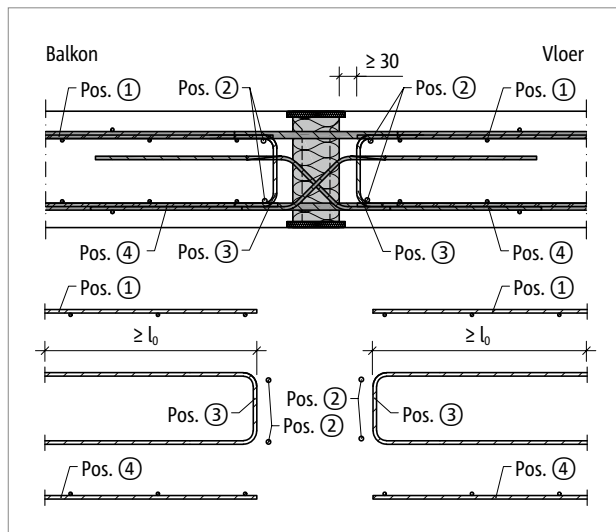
Schöck Isokorf® T type D bij R0: Zijaanzicht
